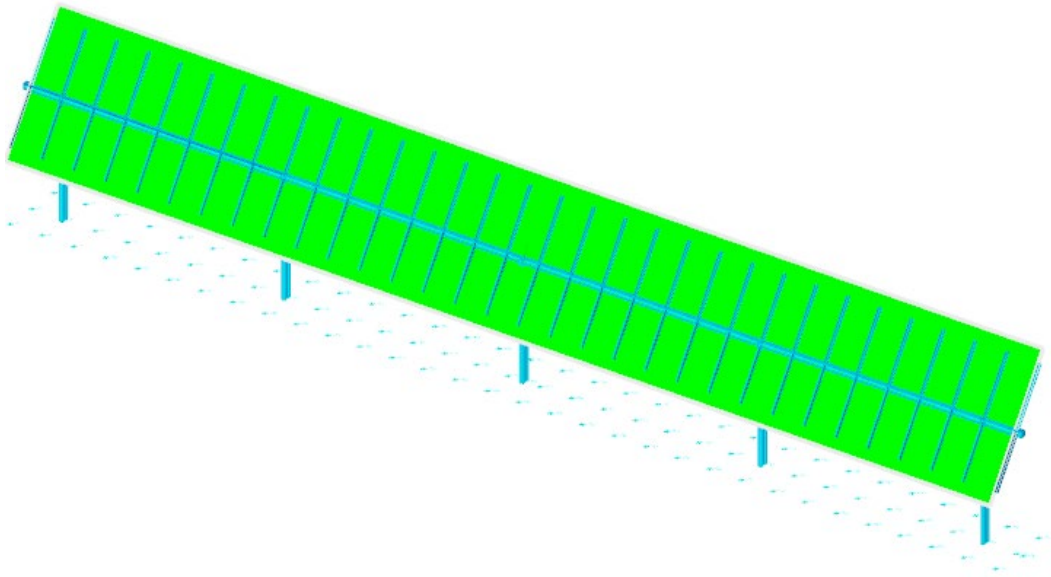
Vista assonometrica modello strutturale con posizione della “vela” inclinata di 60°
